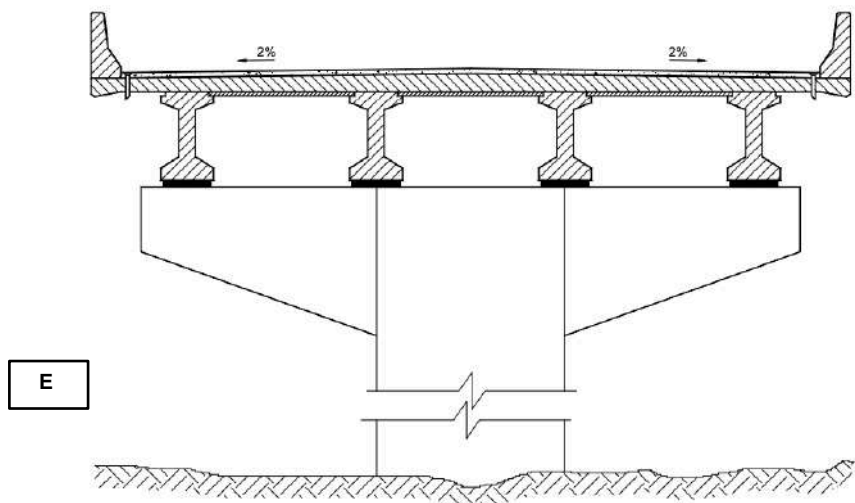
E. Pilar único com viga-trave de seção variável. Fonte: DNIT, 2004
